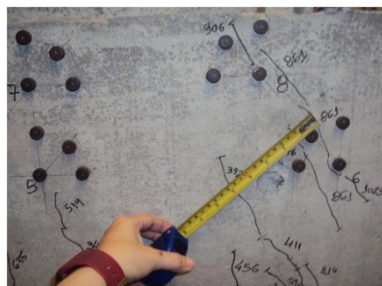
Fissuras no pós-pico B127P500R1
